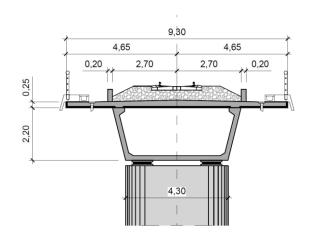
Sección Tipo Tablero Viaducto de L'onyar
